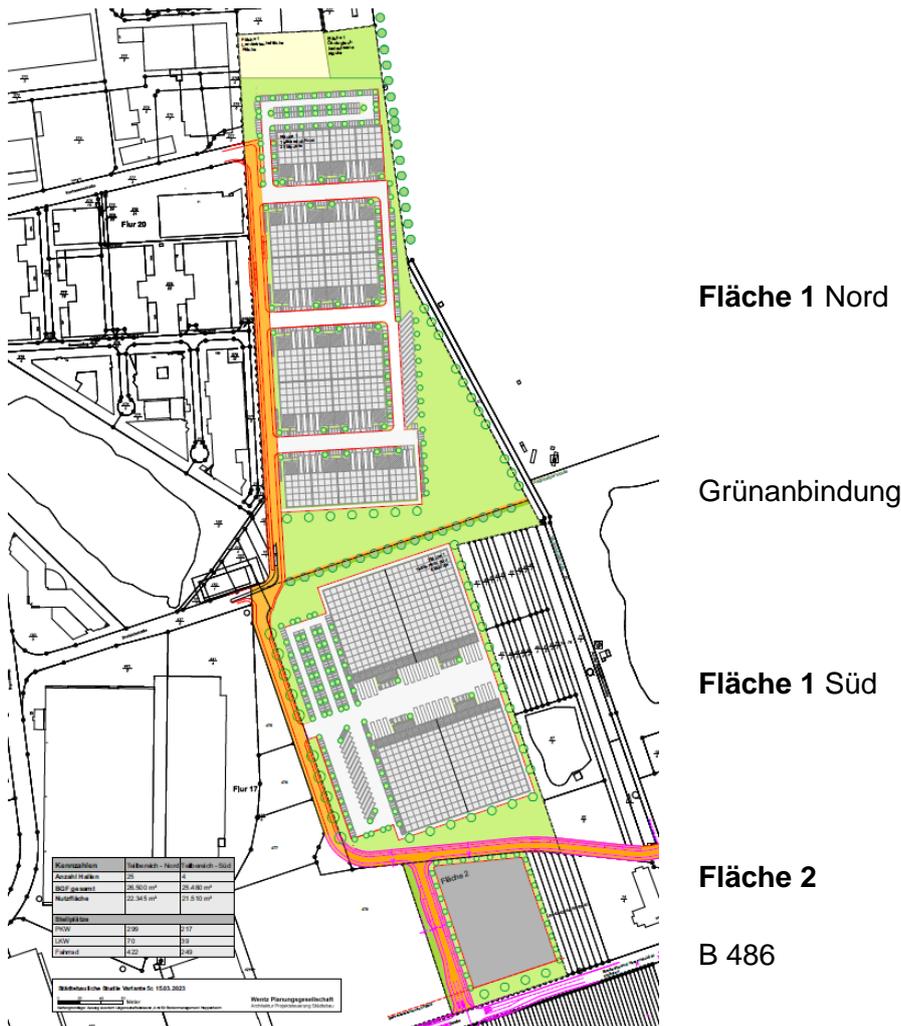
Lageplan, Planentwurf des Gewerbegebiets (Halleninnenstruktur exemplarisch)
